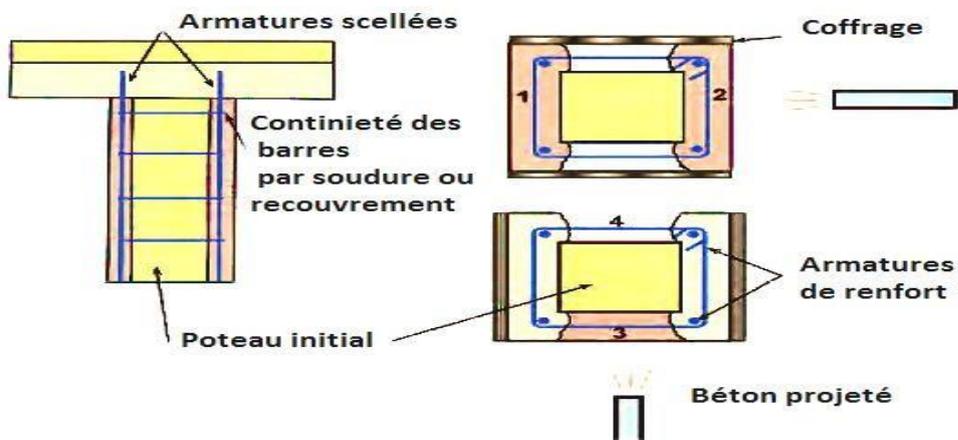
exemple de renforcement d'un poteau par ajout de béton et d'armatures
